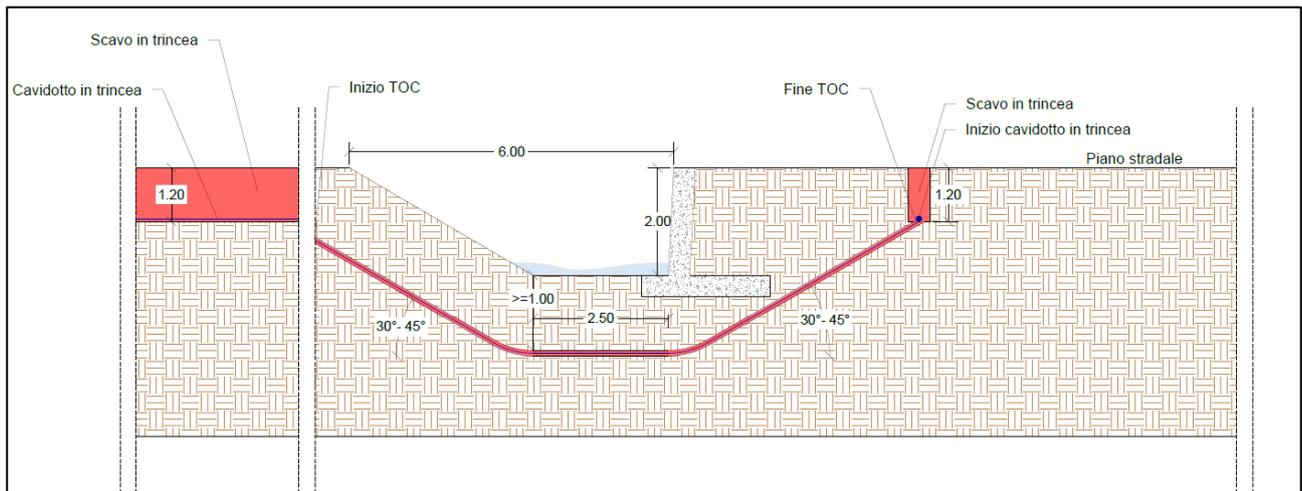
Sezione tipologica attraversamento idraulico n.1 – Canale a perimetro dell'area di impianto
